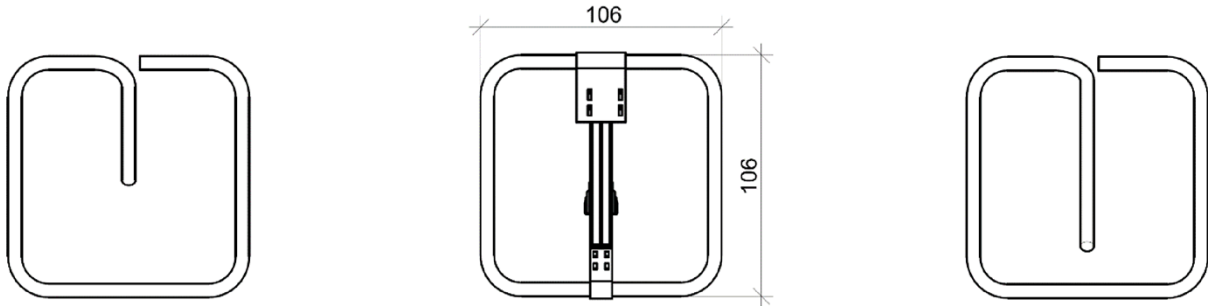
Schöck Isokorb® Typ K mit CCE mit integrierter Vertikalbewehrung gem. Abschnitt D.1.1 und Sonderbügel
